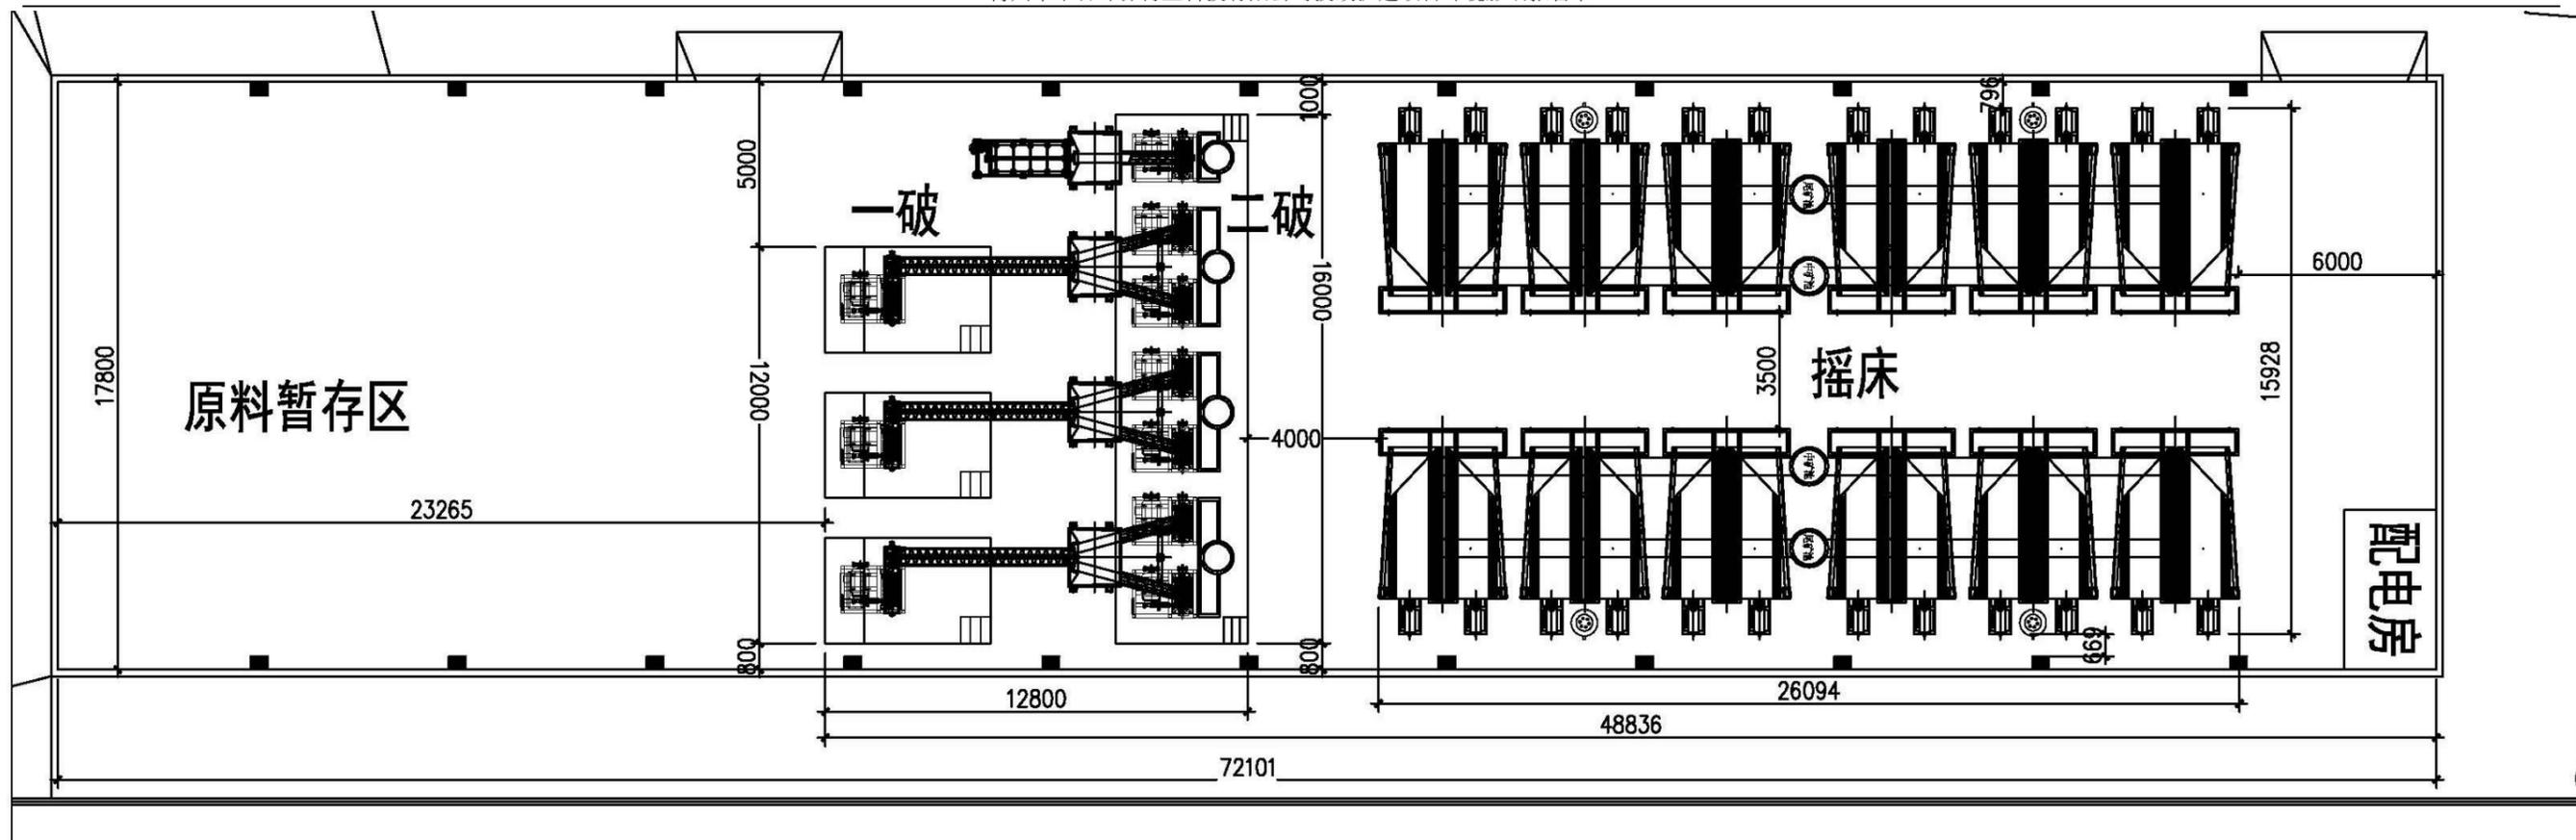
技改扩建项目废电路板湿法分选车间平面图布置图
